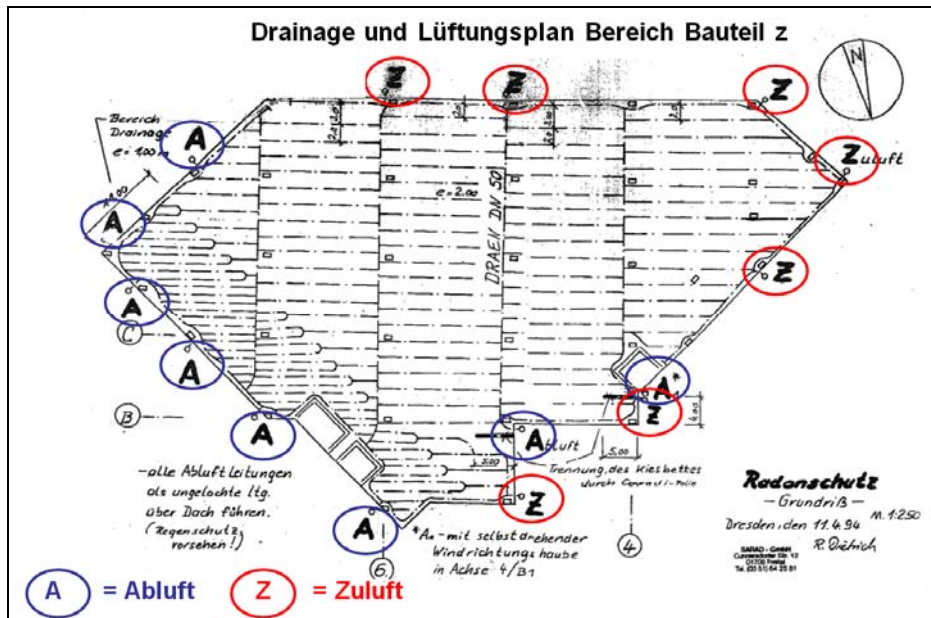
Grundriß Drainagesystem im Bauteil 7
